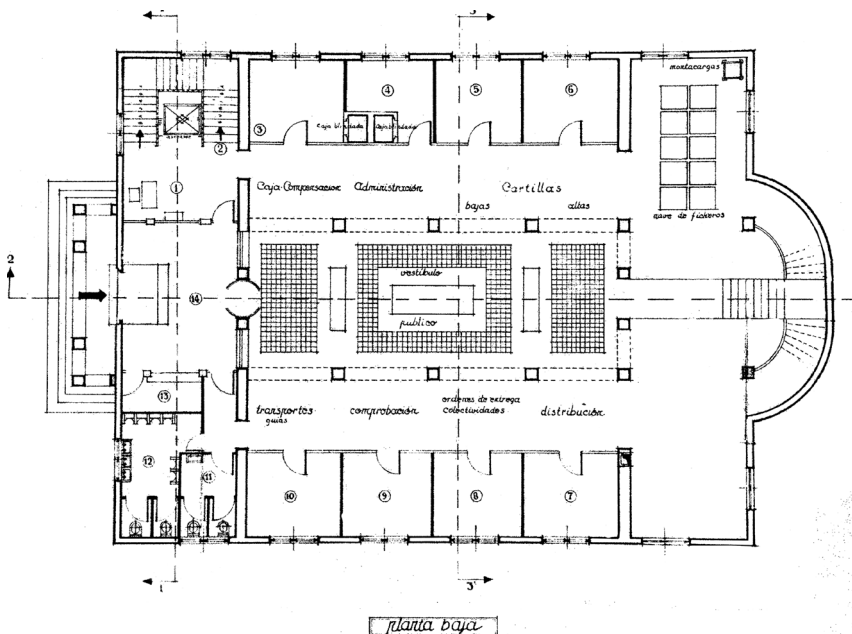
DPAYT. Planta baja. Detalle del plano de plantas. AHPZa. DPV. 10/23.
